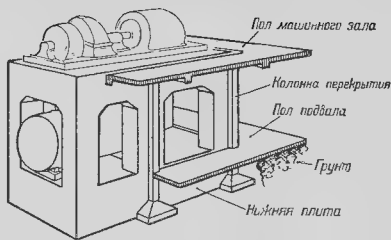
Схема сопряжения фундамента с перекрытием машинного зала.
